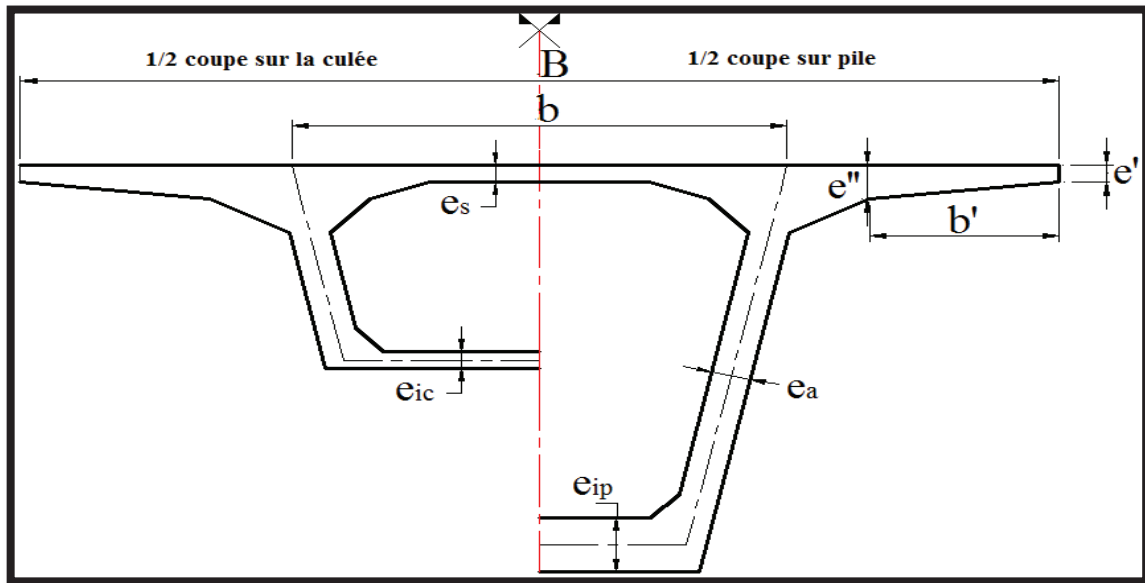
Coupe transversale type d'un caisson simple à deux âmes
